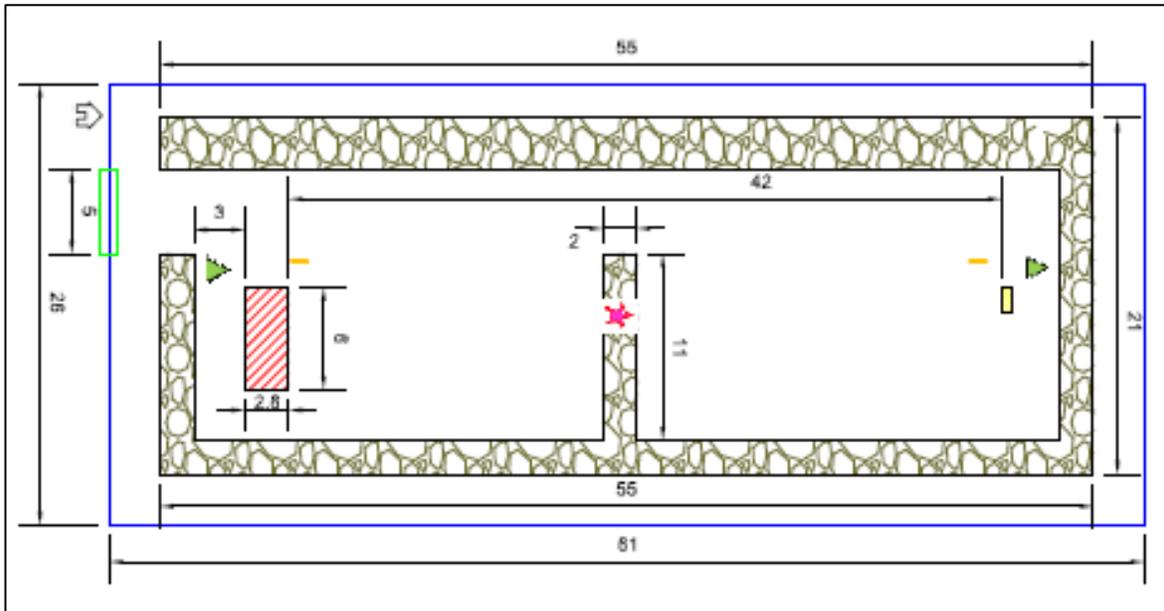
Vista en Planta del Polvorín tipo a construir en la obra de Chada.
